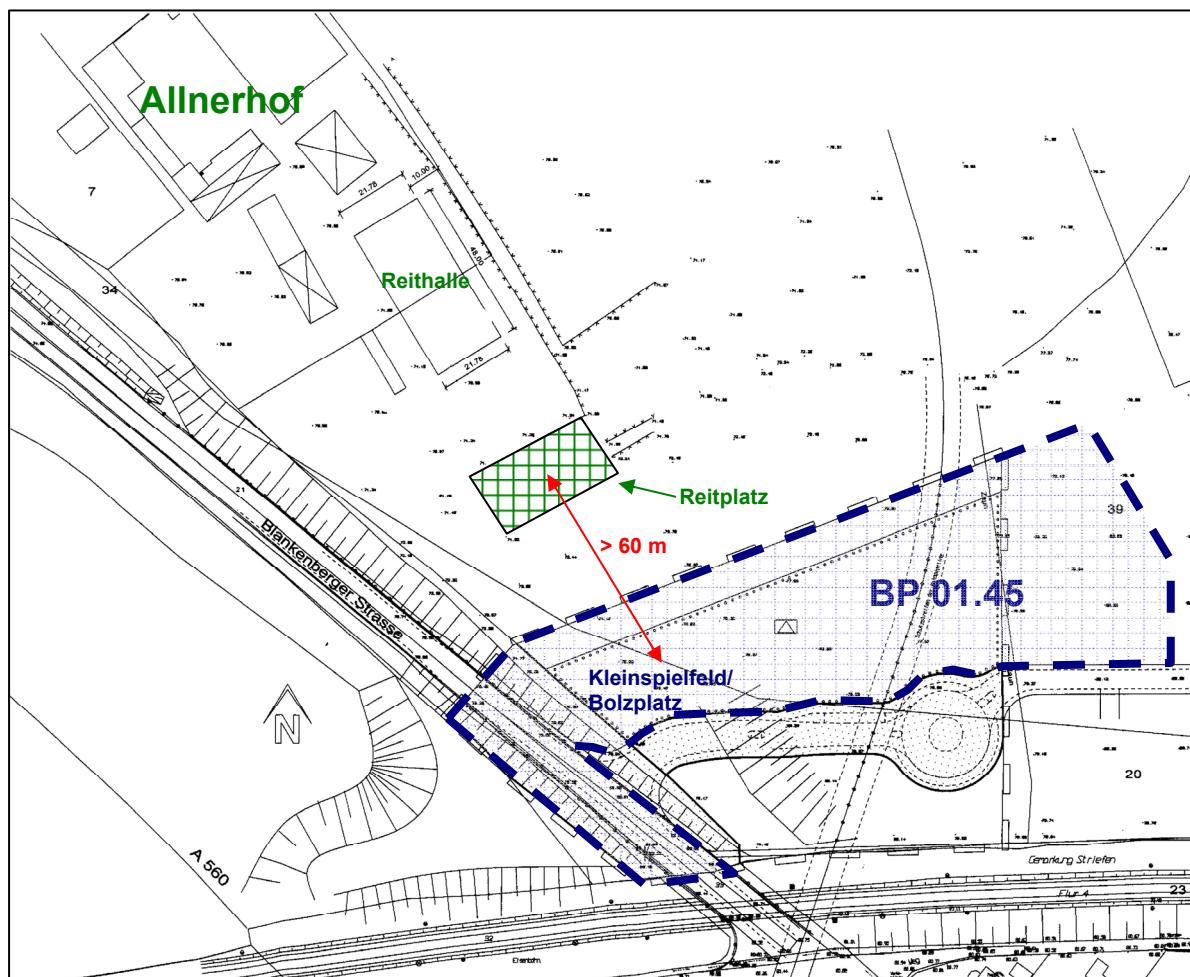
Lageplan Allnerhof und Plangebiet mit Kleinspielfeld, M 1:2.250
